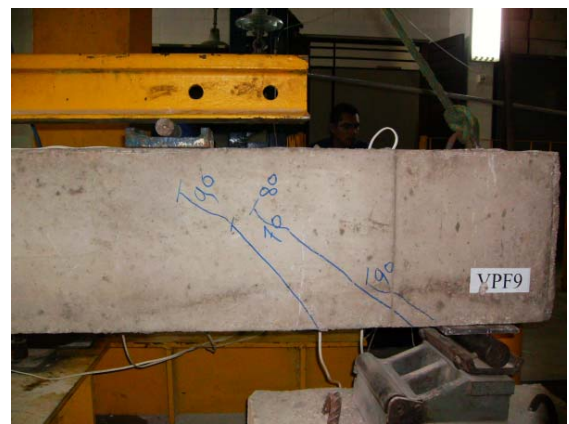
Padrão de fissuração da viga VPF9 (ruína por cisalhamento)
